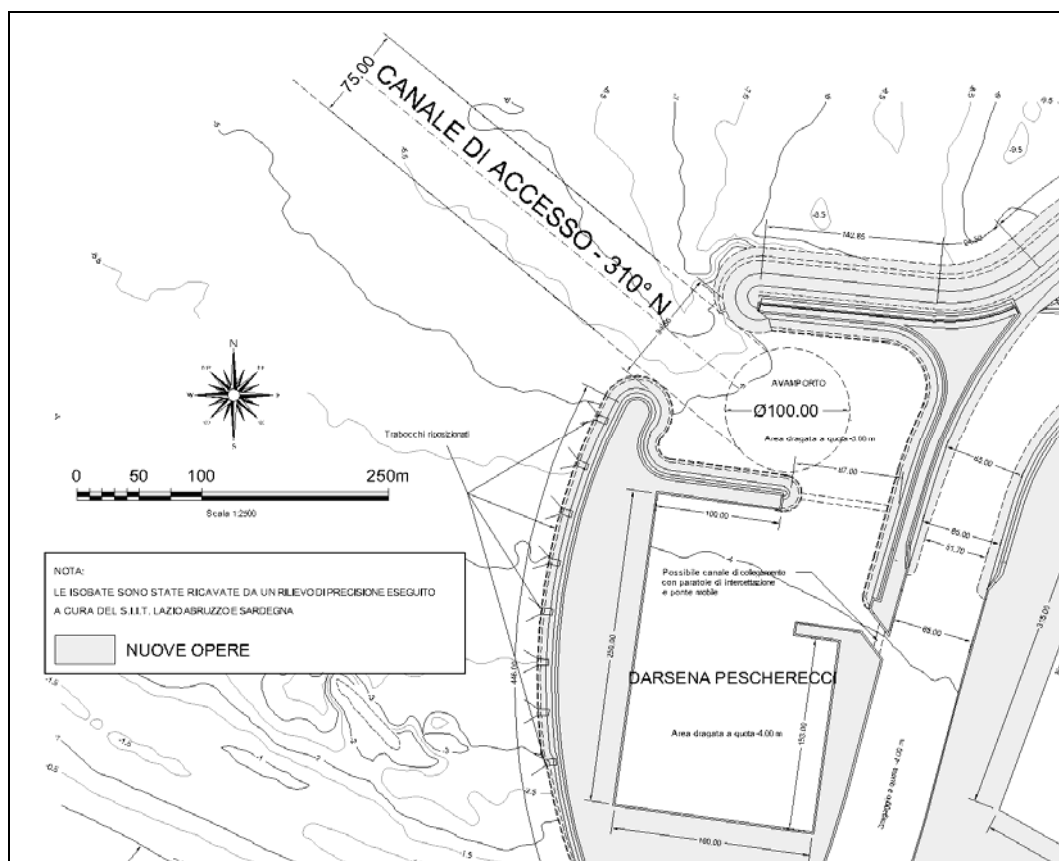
Bacino pescherecci: planimetria di progetto con l'indicazione del canale di accesso
